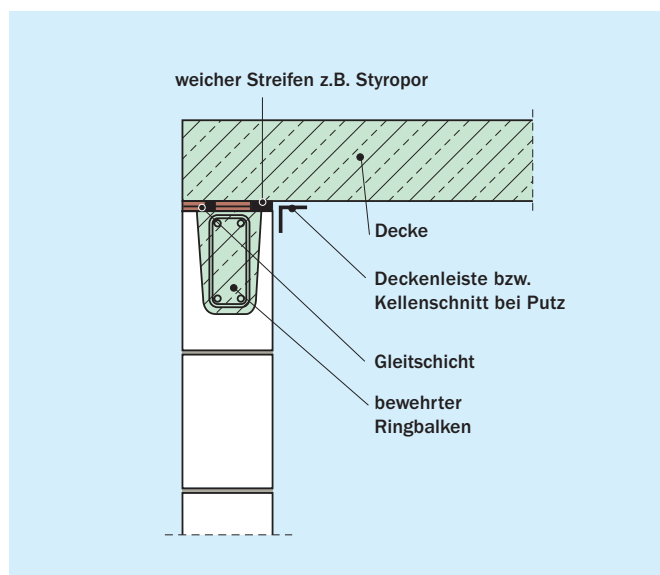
Konstruktive Maßnahmen zur Zentrierung der Deckenauf-lagerkraft am Beispiel der Außenwand unter einer unge-dämmten Dachdecke – Gleitlager mit weichem Streifen an der Wandinnenseite
